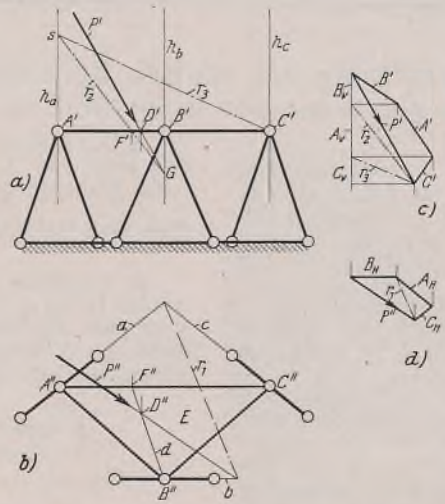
a u. b. Auf- und Grundriß des Fachwerks. Bild 3 c u. d. Kräfteplan für Auf- und Grundriß.
